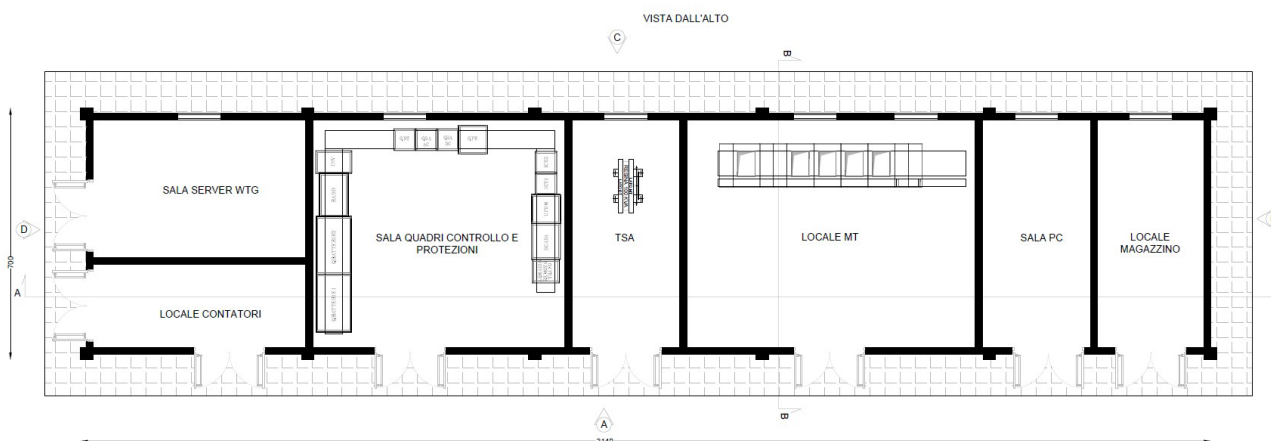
Planimetria fabbricato stazione di utenza (misure in cm)
